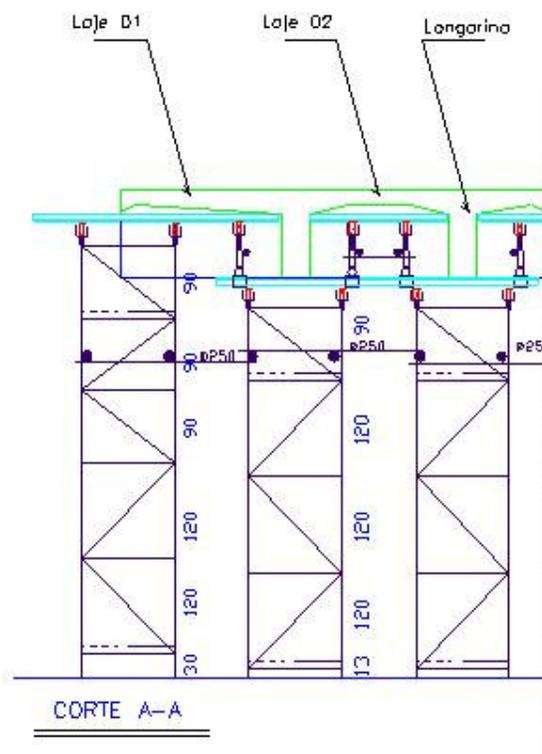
Projeto de escoramento metálico. Fonte: ilustração Jorge Souza
